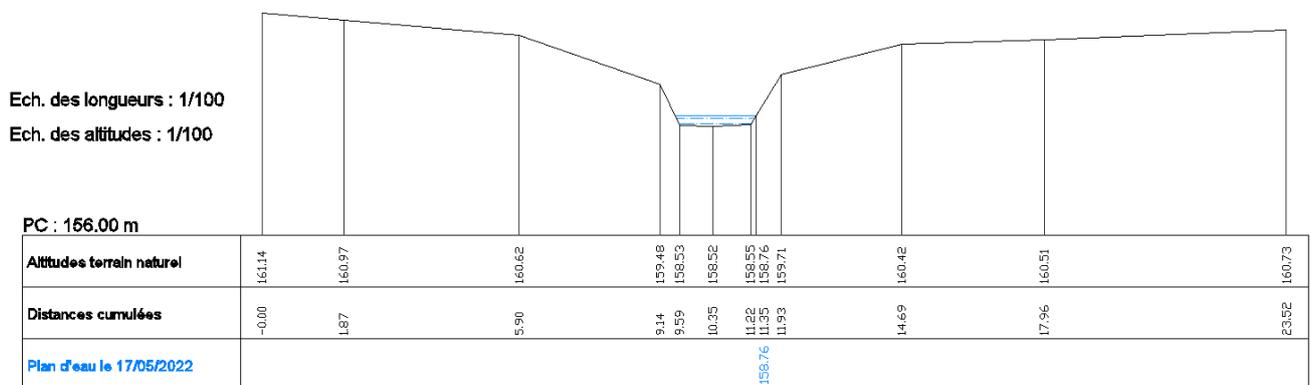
Profil en travers du lit actuel du ru d'Erlant (Source : HYDROTOPO)
